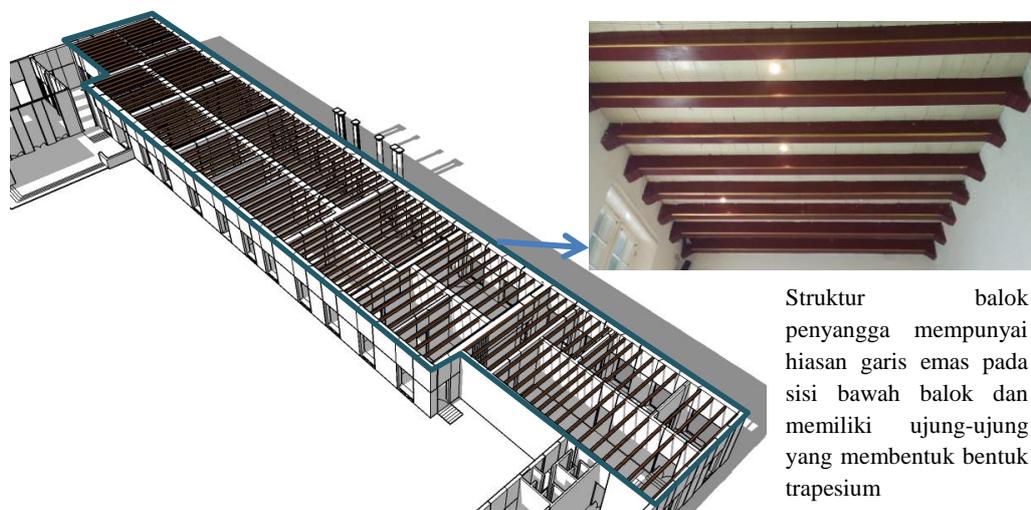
Sturuktur Dinding pemikul lantai 1 bangunan Museum Fatahillah
